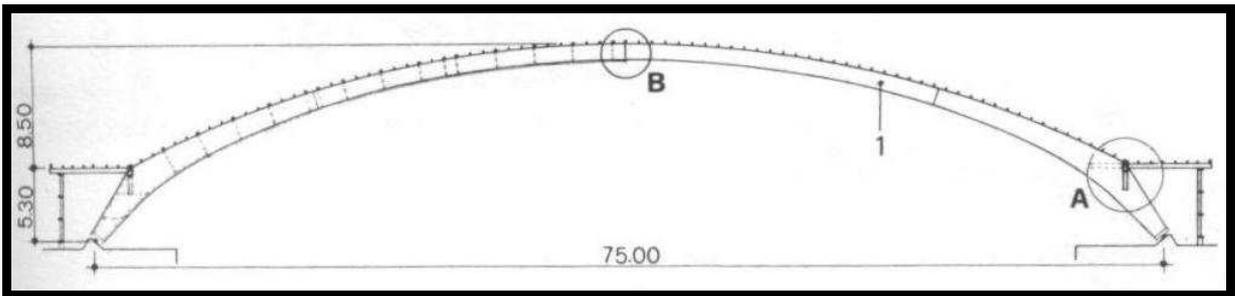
Pavilhão multifunções em Leindon (Holanda)
